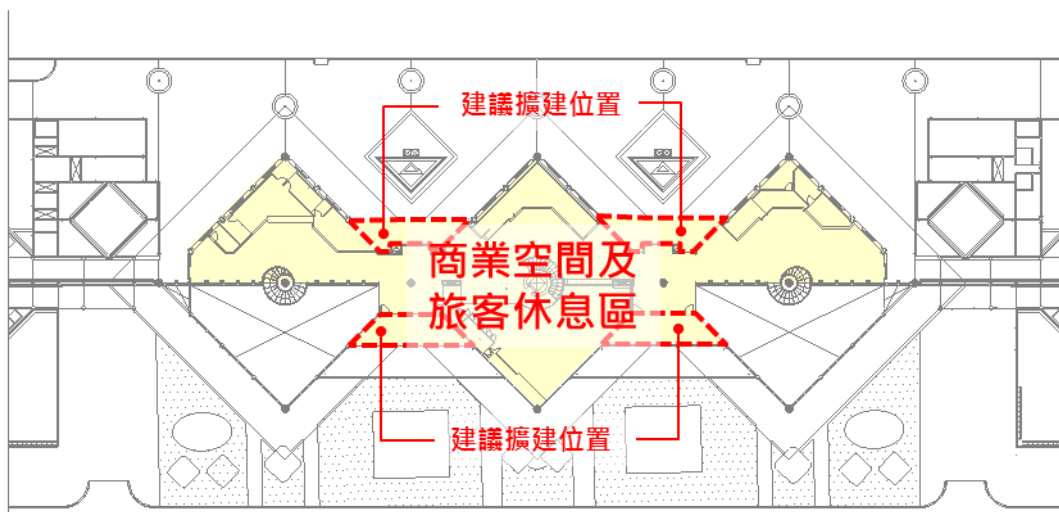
關廟服務區北上站建議增建方案二樓平面圖
